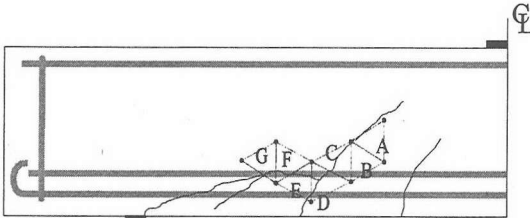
ひび割れ図および変位測定箇所 (T1)
